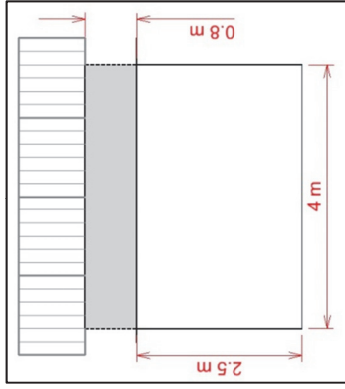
Estructura M02, culvert accés a Can Jover, sobre el rial de Cal Misser.
